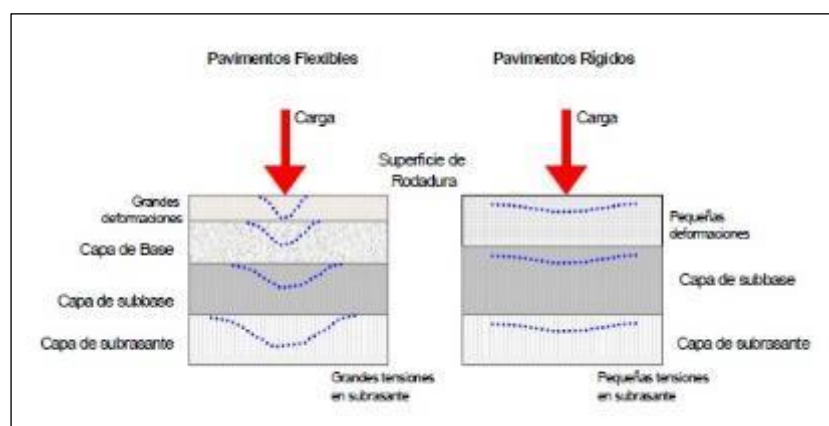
Esquema de comportamiento de pavimentos flexibles y rígidos
